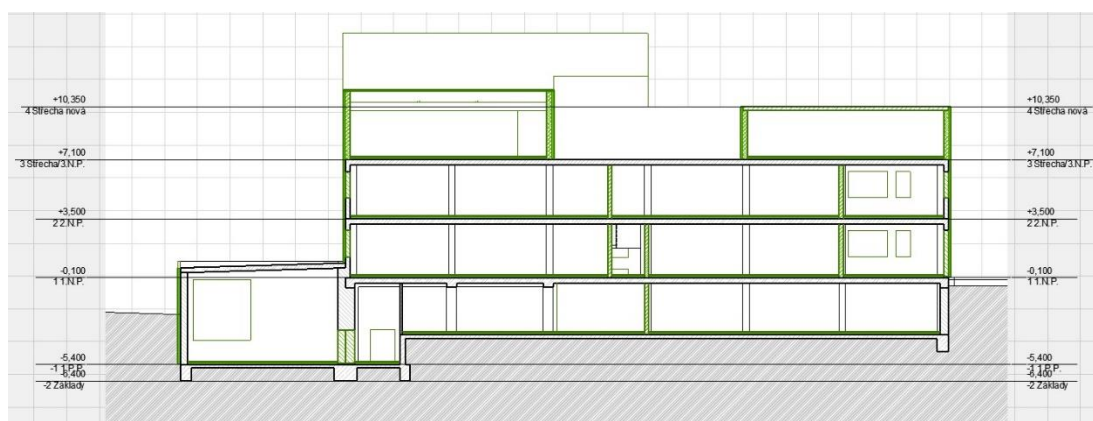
Řez jinou budovou s viditelným nastavením podlaží
